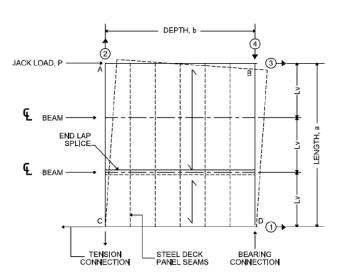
Schémas de bâti d'essai de diaphragme (ICC-ES AC43)
